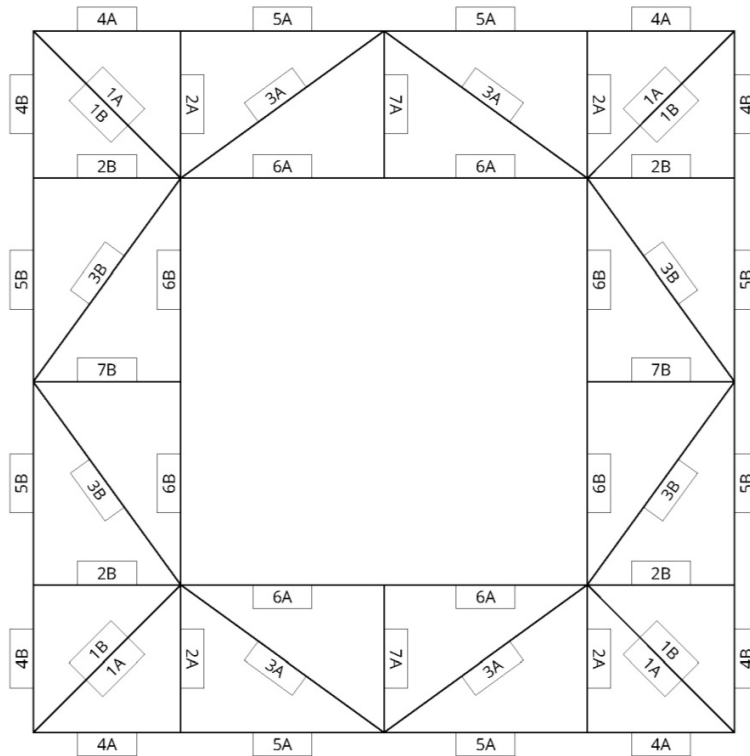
Identificación de los elementos estructurales. FUENTE: Elaboración propia.
